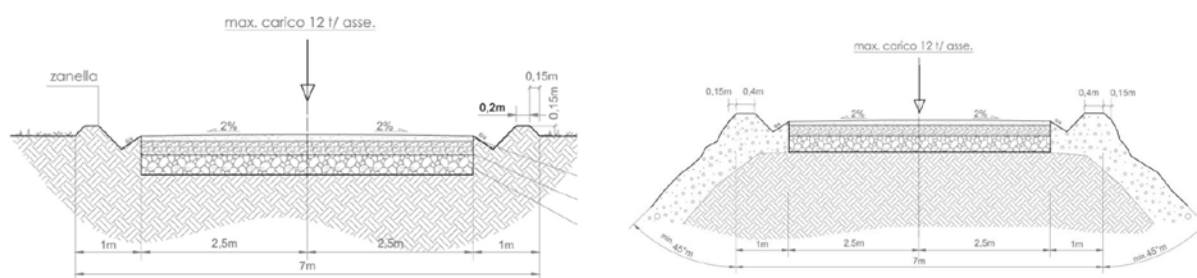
Sezione stradale tipo in piano (a sinistra) e sezione stradale tipo in rilevato (a destra)
